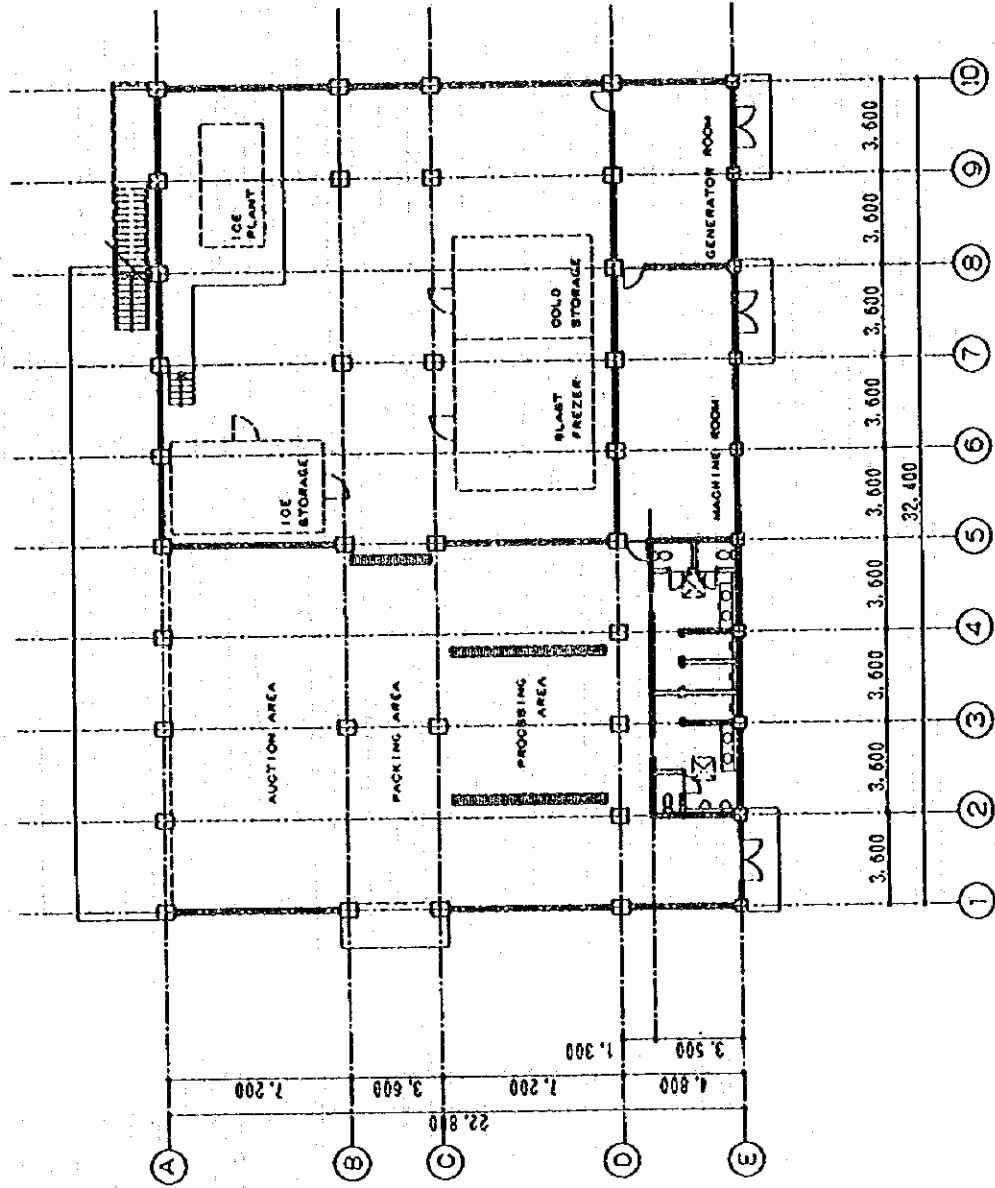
・8-4 アッサブ 魚市場製氷冷蔵棟 平面図 (1階)
